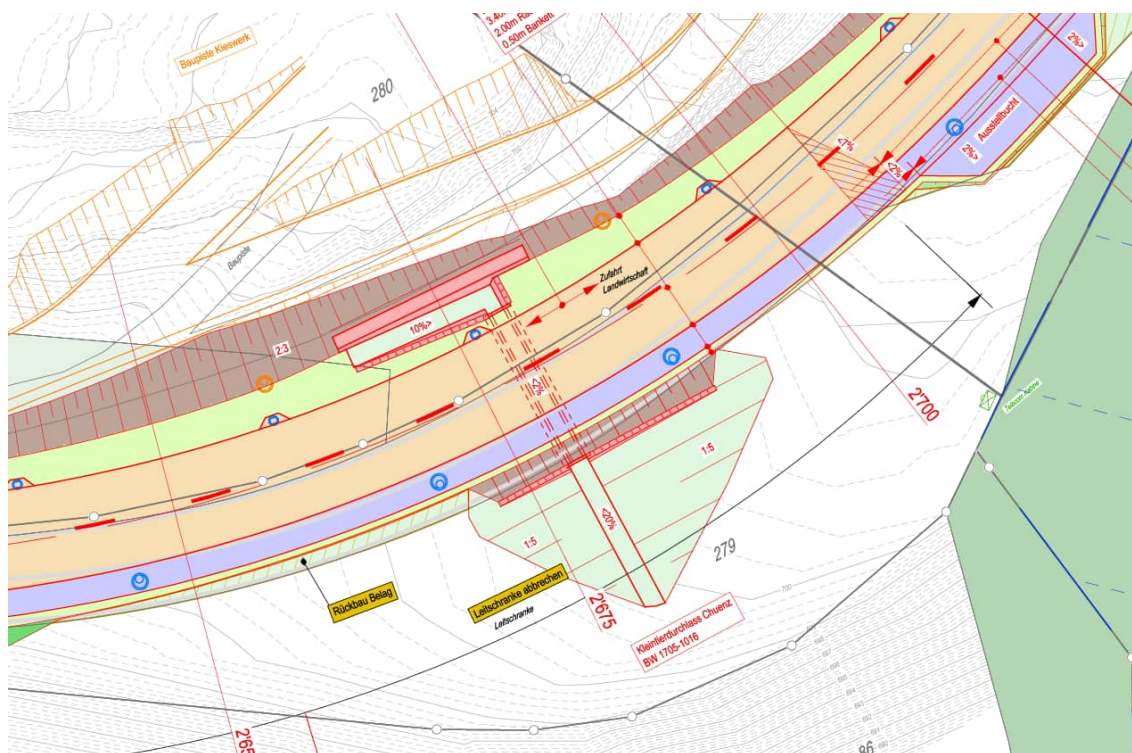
Lage des Kleintierdurchlasses im Projekt (Ausschnitt aus Situationsplan [2])
